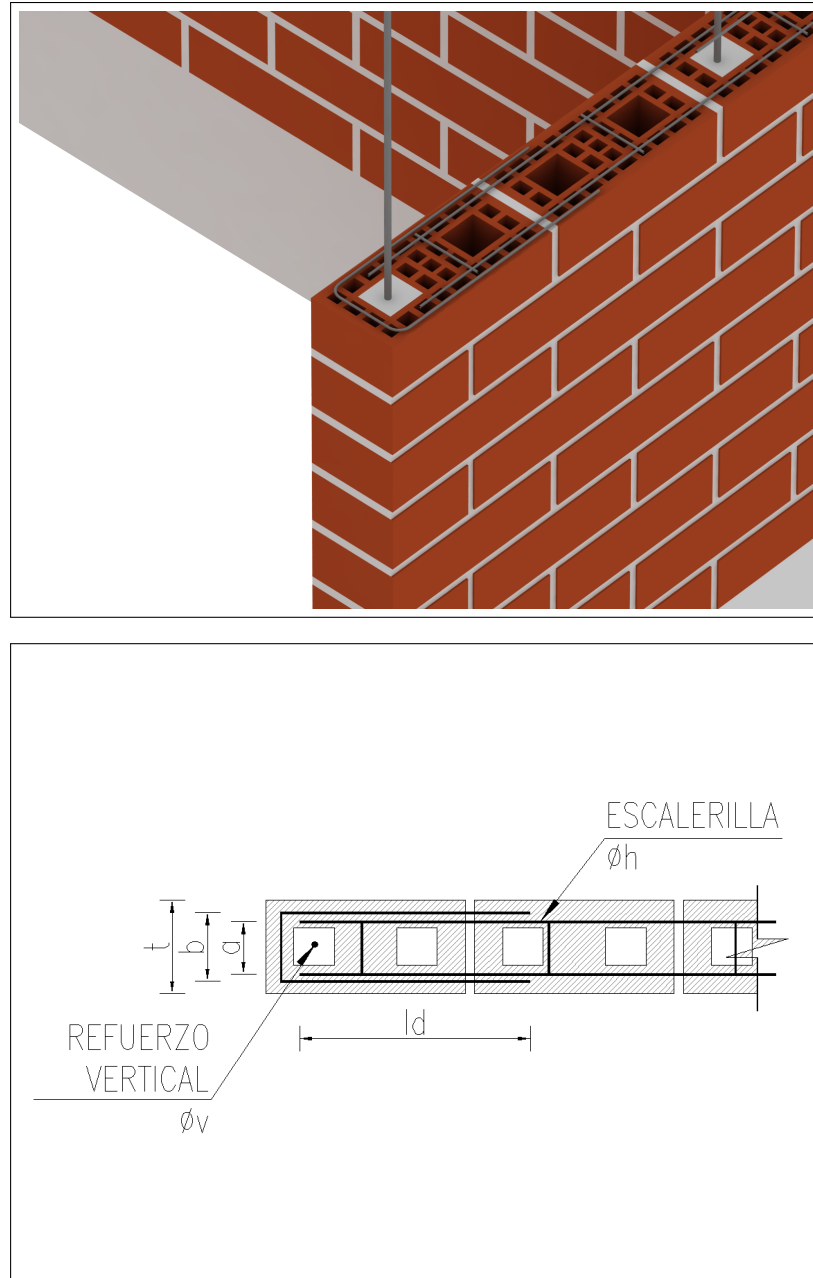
Anclaje del refuerzo horizontal (escalerilla) en el borde libre de un muro. Alternativa B.
